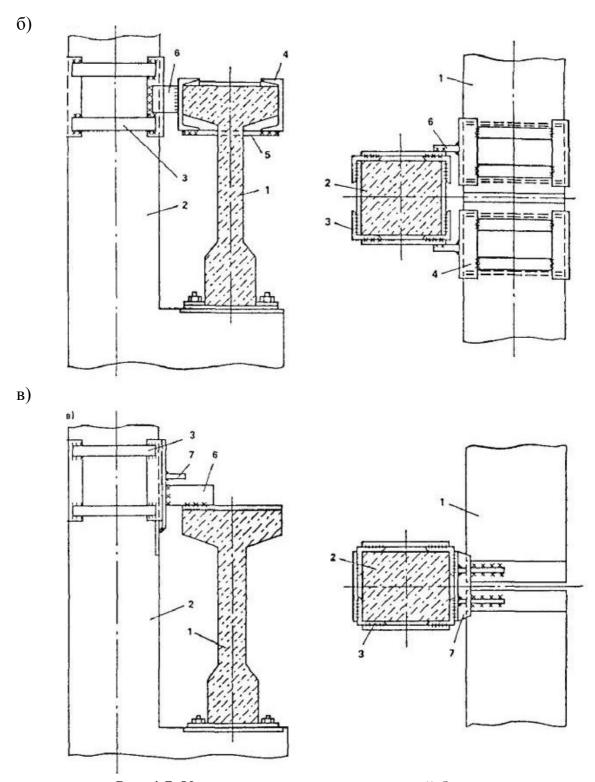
Усиление крепления подкрановой балки к колонне
